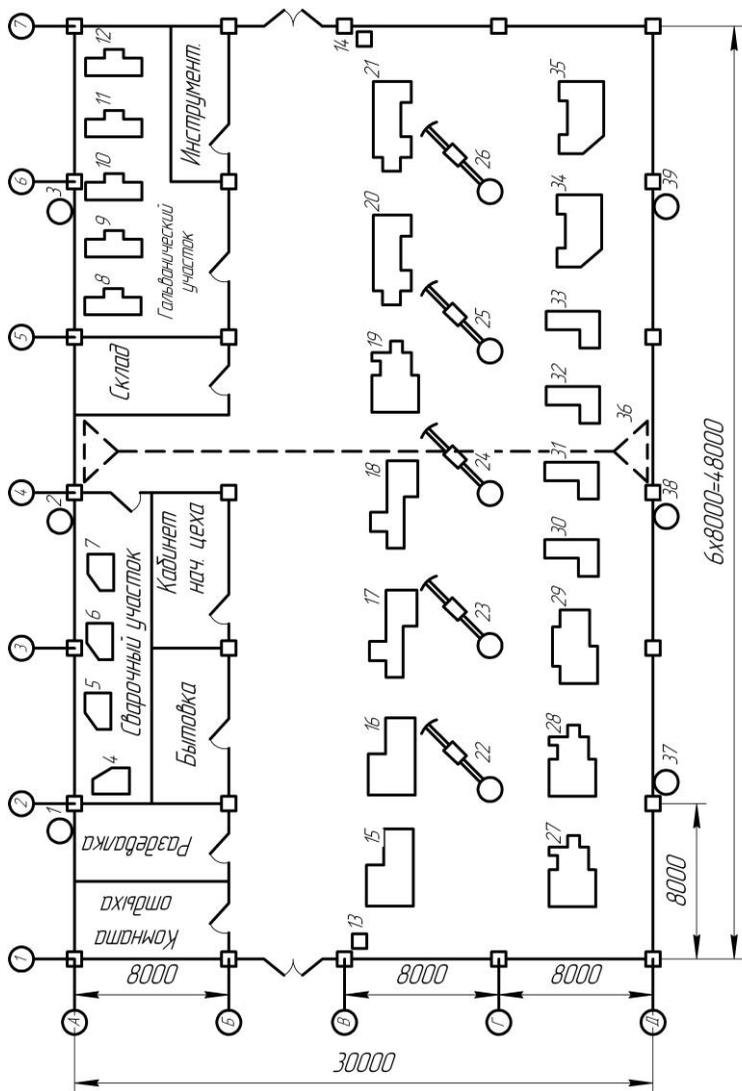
План расположения ЭО цеха обработки корпусных деталей
